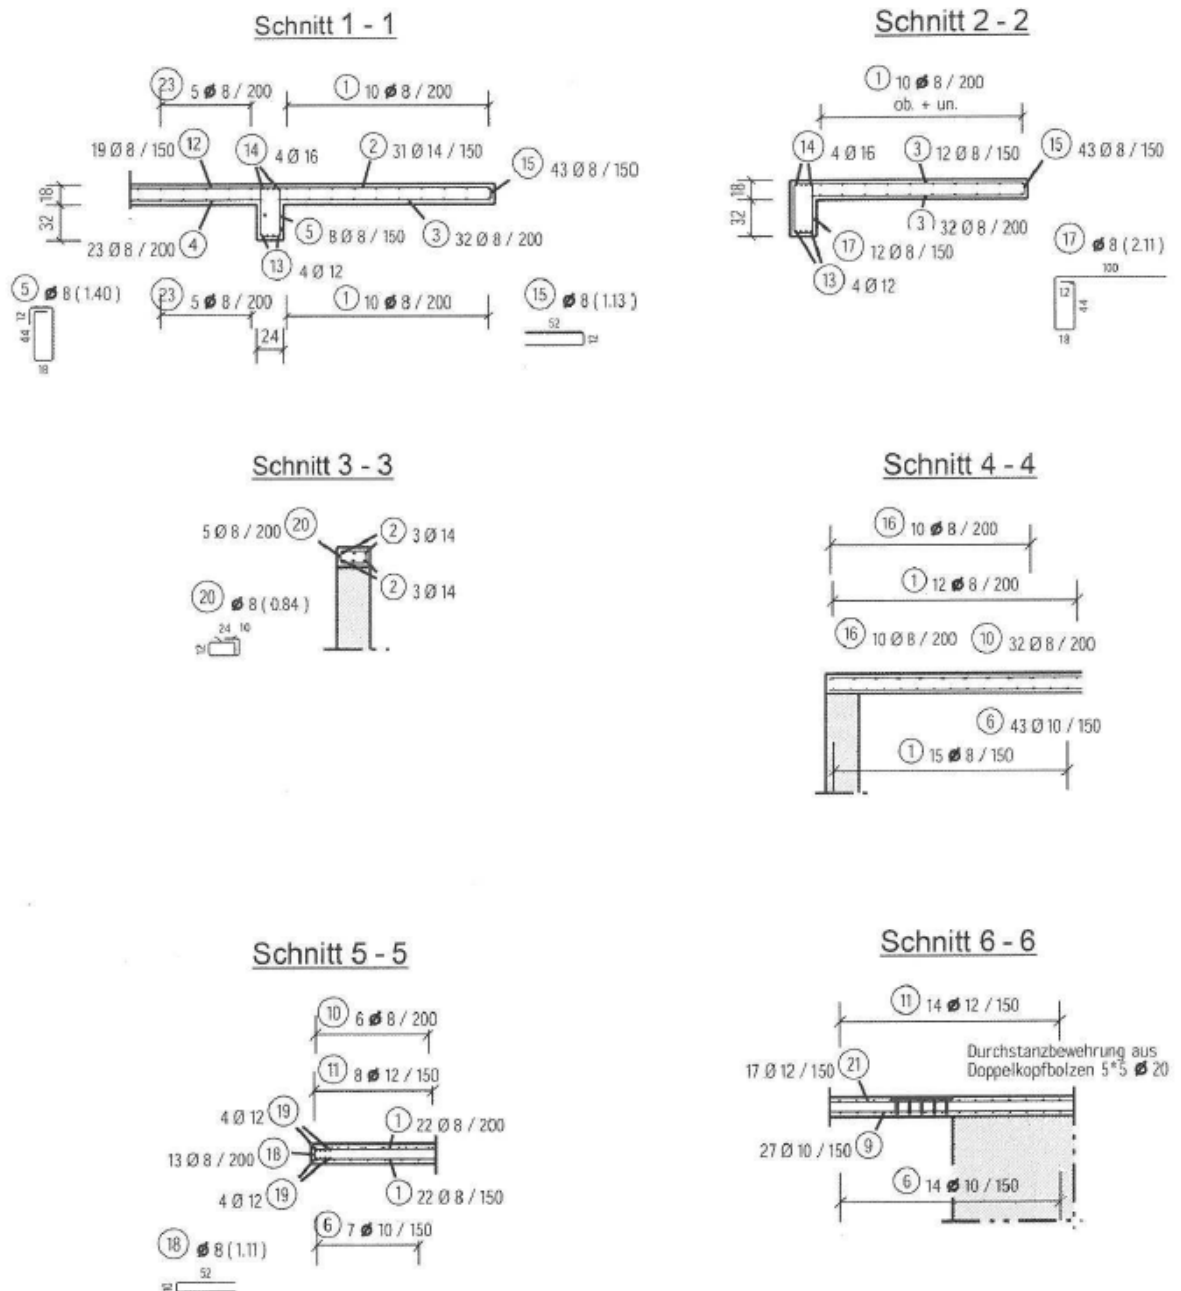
Bewehrungsführung in der Deckenplatte (Schnitte)
